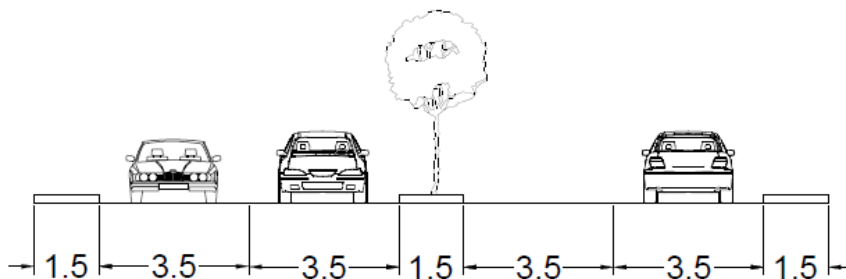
Sección Transversal Av. Rómulo Betancourt. (Fuente: Elaboración Propia).
